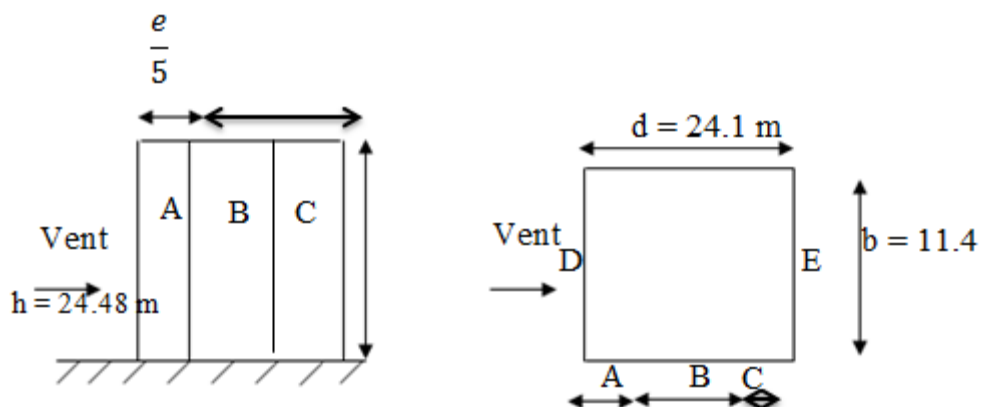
Vue en élévation et vue en plan Cas ou $d > e$ sens-Y.
